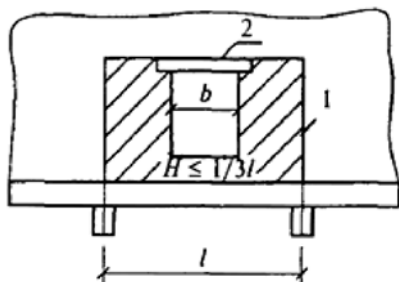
Схема нагрузки на рандбалку при наличии проема в стене: 1 — нагрузка на рандбалку; 2 — железобетонная перемычка
